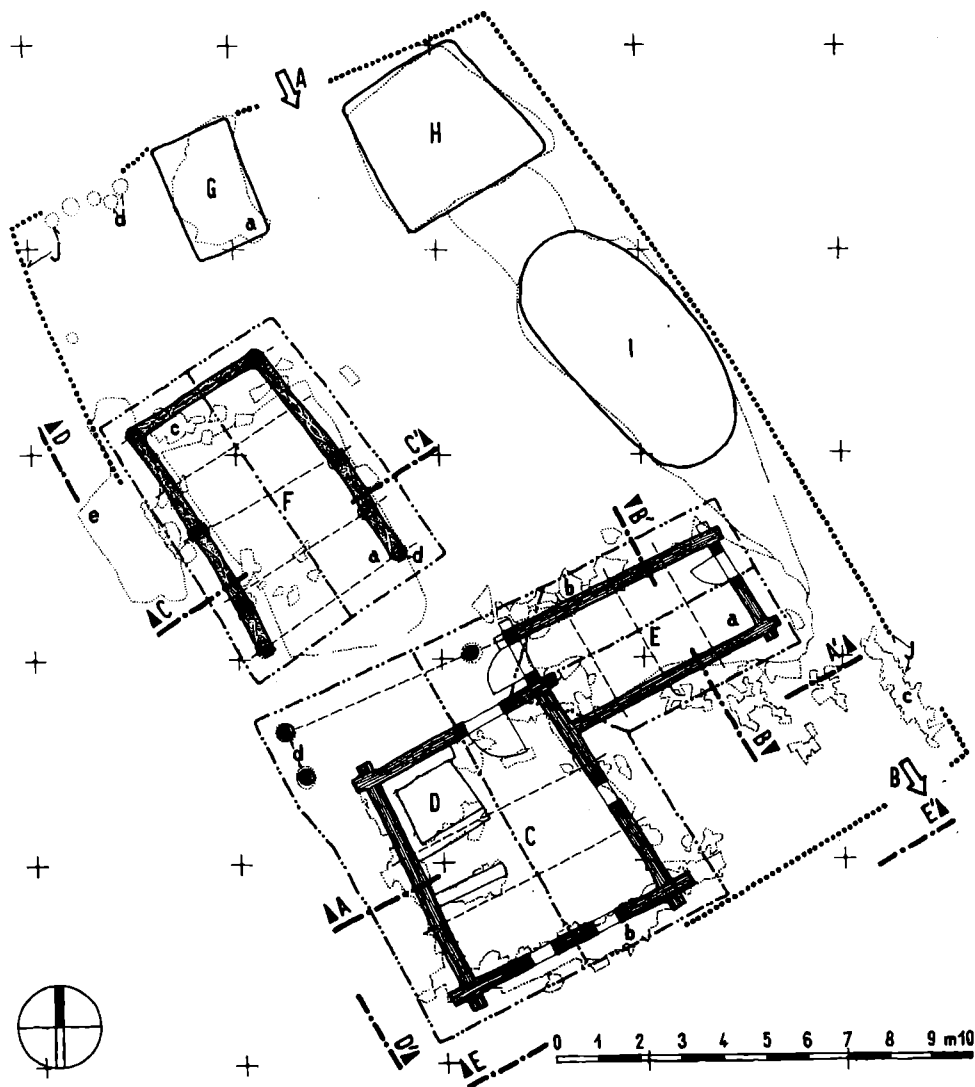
Rekonstrukce půdorysu usedlosti I (kresba autor).
